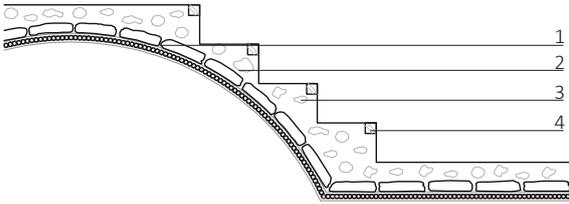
Detalle escalera cañizo y lajas de piedra Fuente: propia
